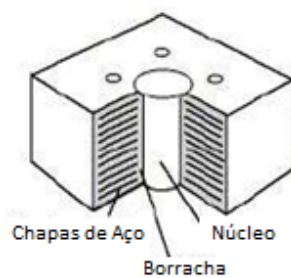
Ilustração da constituição interna de um apoio LRB (adaptado de Saiful Islam et al., 2011)
